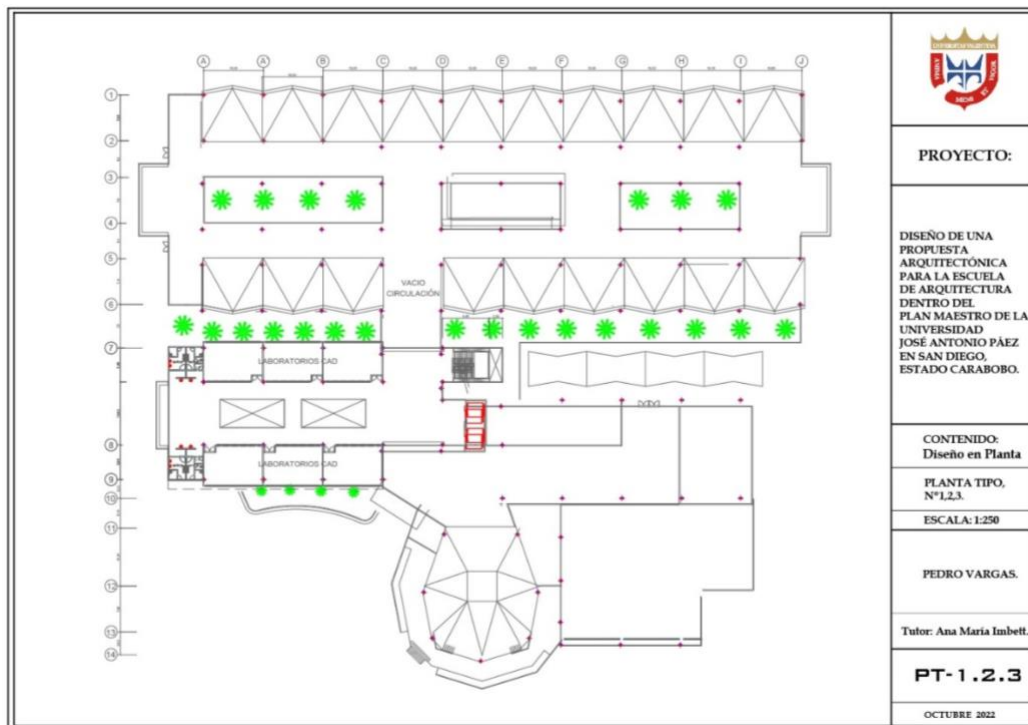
Plano de diseño en vista de planta para los pisos tipo 1,2,3.
